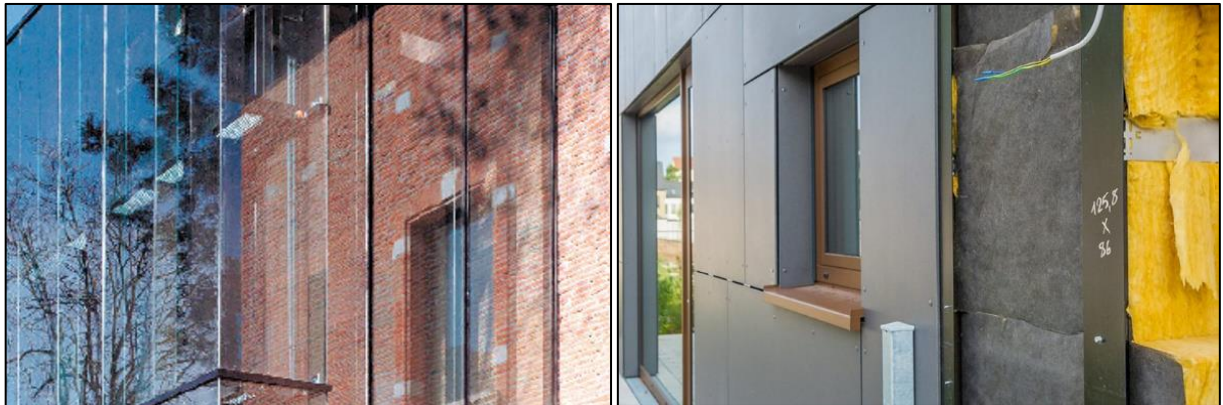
Exemples d'isolation par l'extérieur des façades, vitrée ou non, modifiant considérablement l'aspect architectural d'un bâtiment
